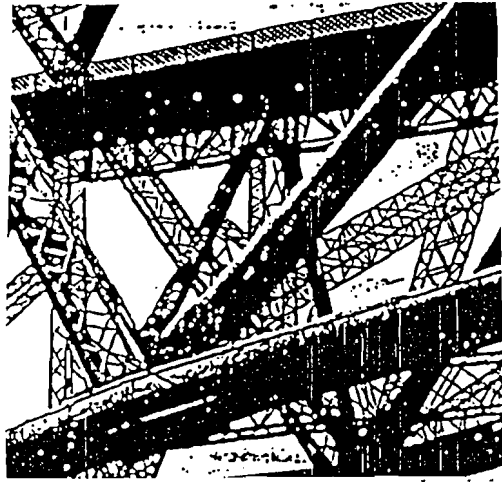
Sistem stabilitas struktur sekaligus memberi nilai estetika pada bangunan.
